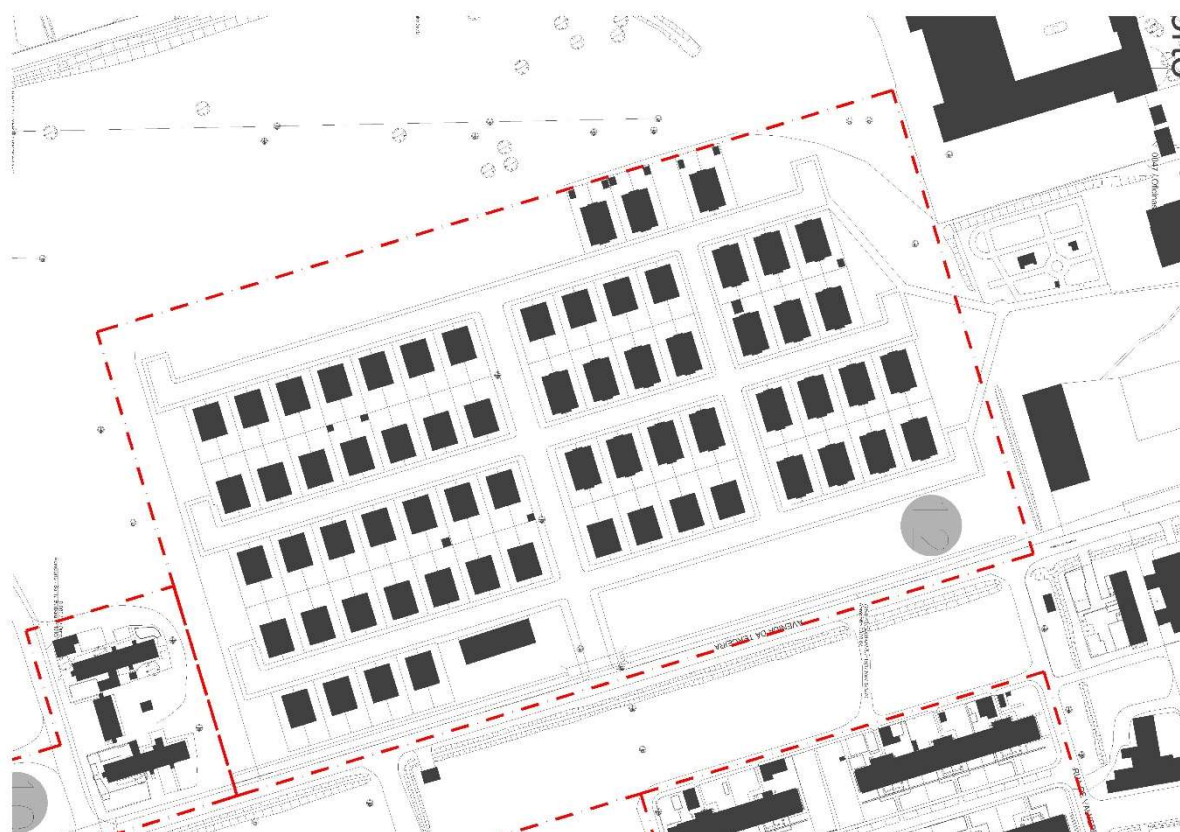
Planta do Bairro da NAV (Extrato de Planta Cedida Pelas Ilhas de Valor)
